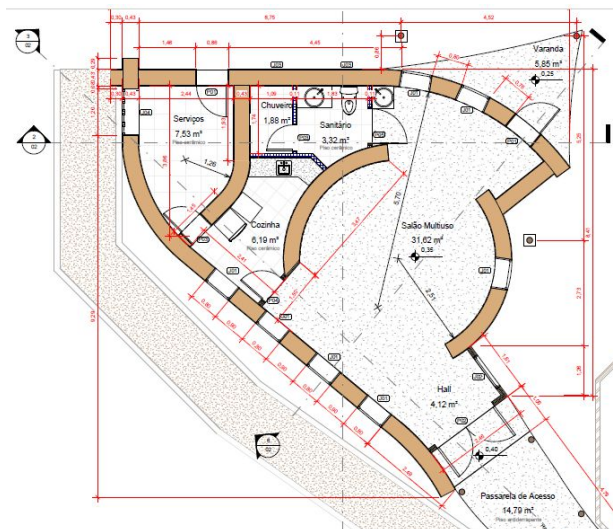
Planta baixa da edificação. Fonte: acervo da autora.
